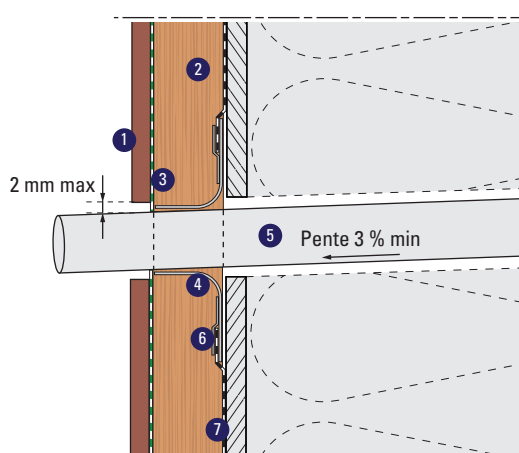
Exemple de traitement de la traversée d'une paroi avec collerette d'étanchéité avec joint à lèvres dans le plan du bardage - coupe verticale
